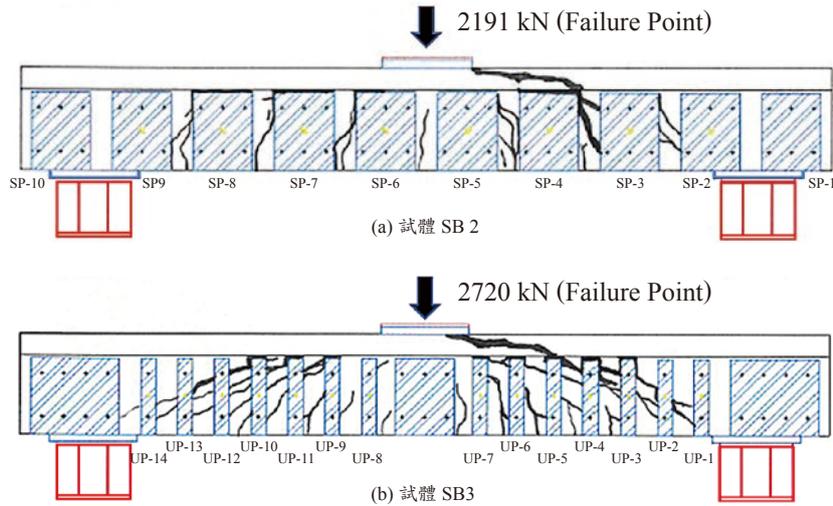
鋼筋混凝土梁剪力補強試體 SB2 及 SB3 試驗結果
